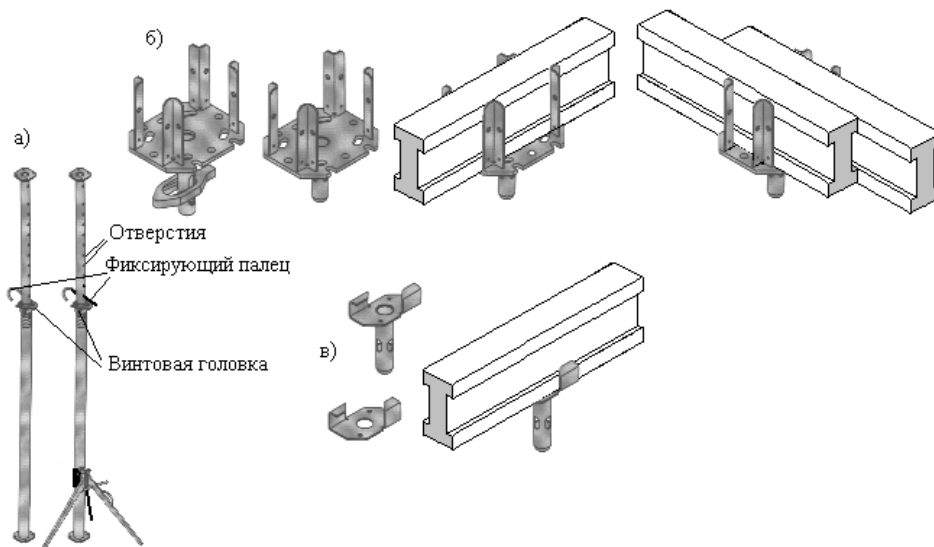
Стойки горизонтальной опалубки: *а* – стойка с треногой; *б* – головка основных стоек; *в* – головка промежуточных стоек
